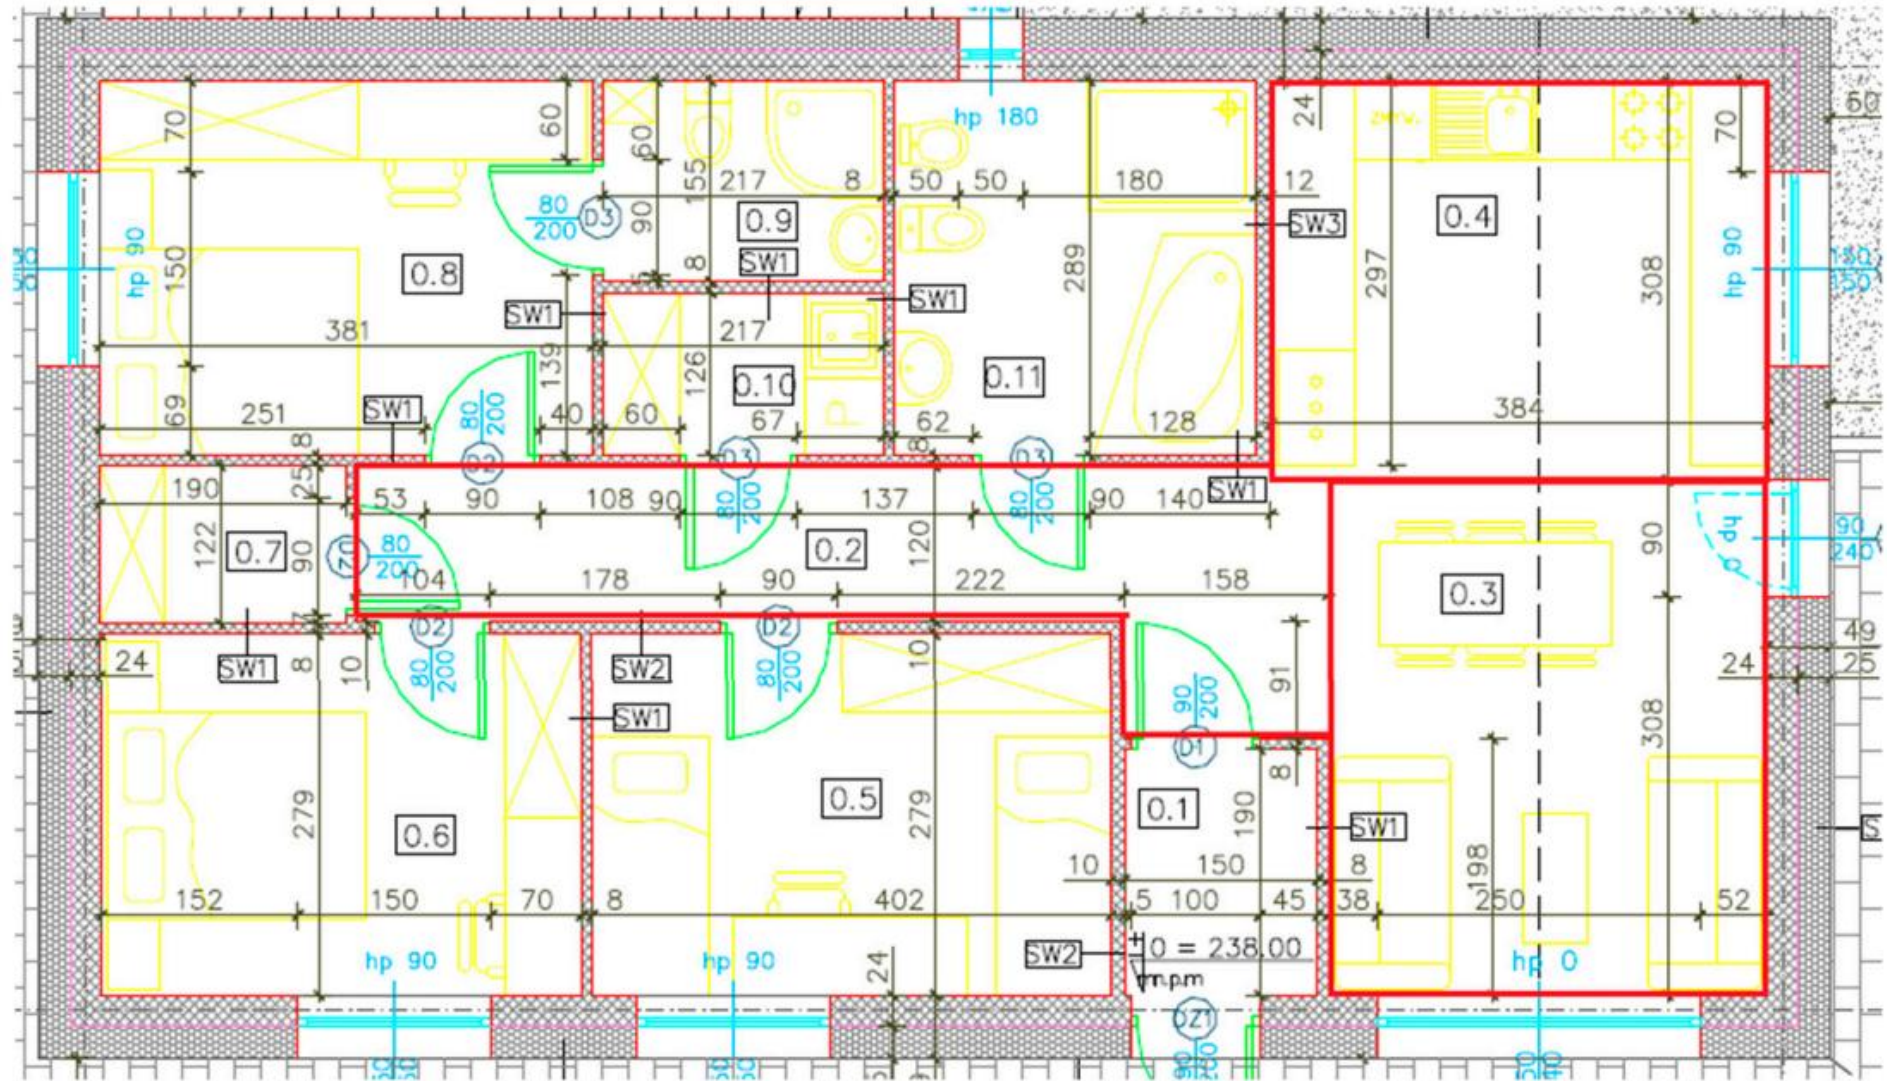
Планування одного поверху (першого поверху) змодельованої будівлі
